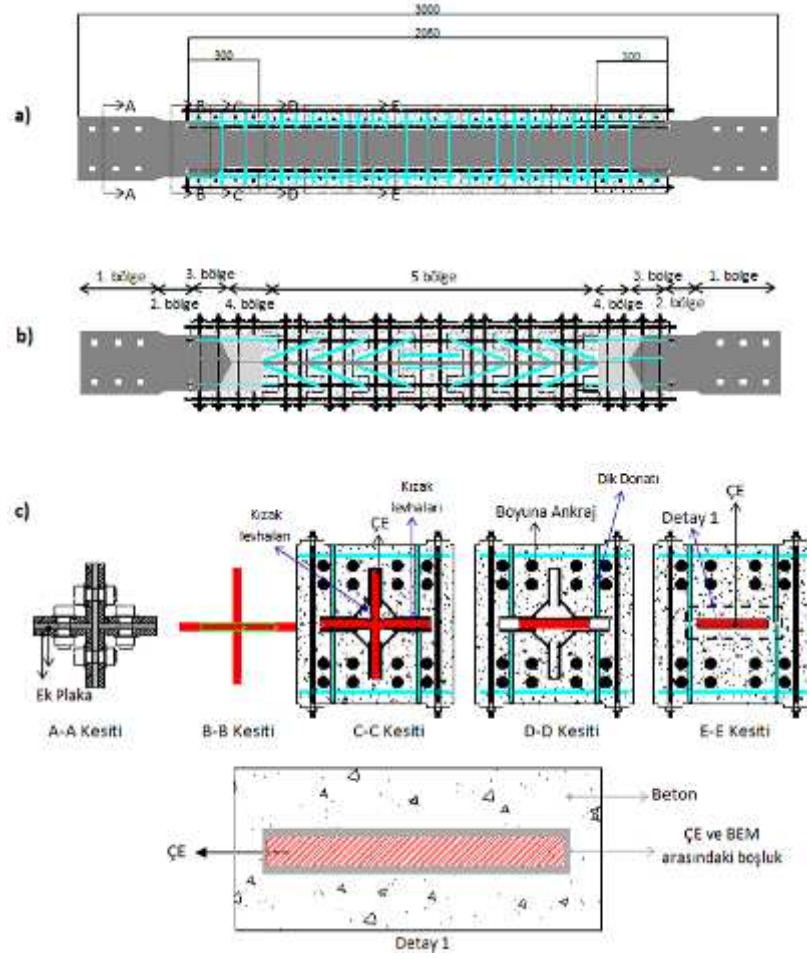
4. BEÇÇ\_3 elemanı detay çizimleri
